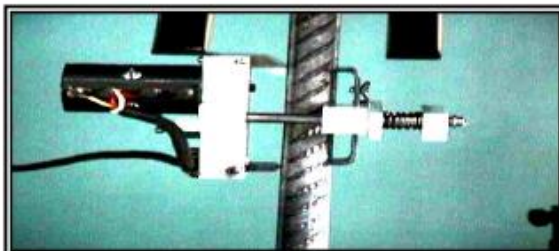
Deformímetro LVDT utilizado para obtener
